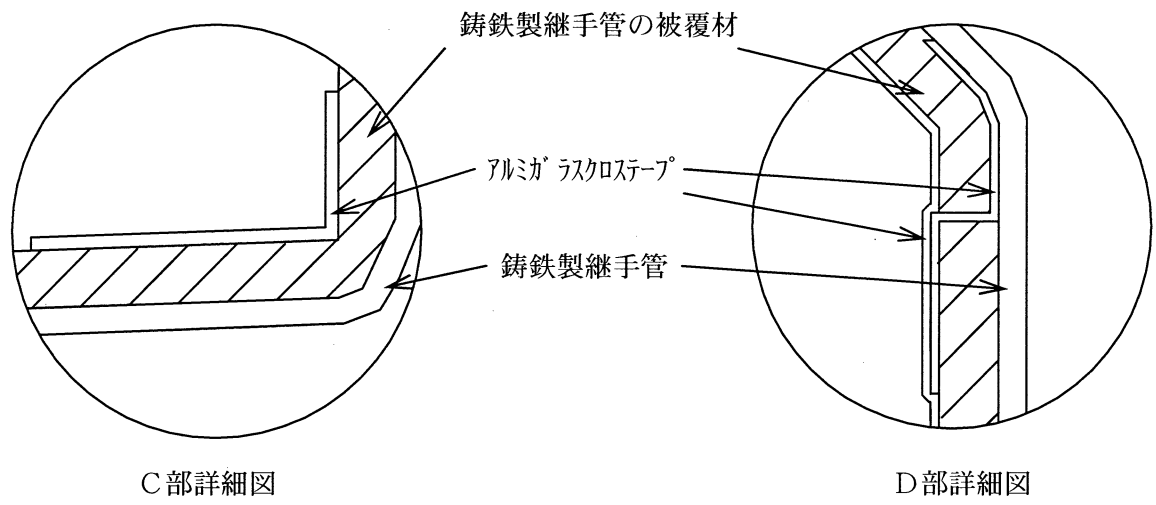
延焼防止材付鋳鉄製継手管の被覆部詳細図
